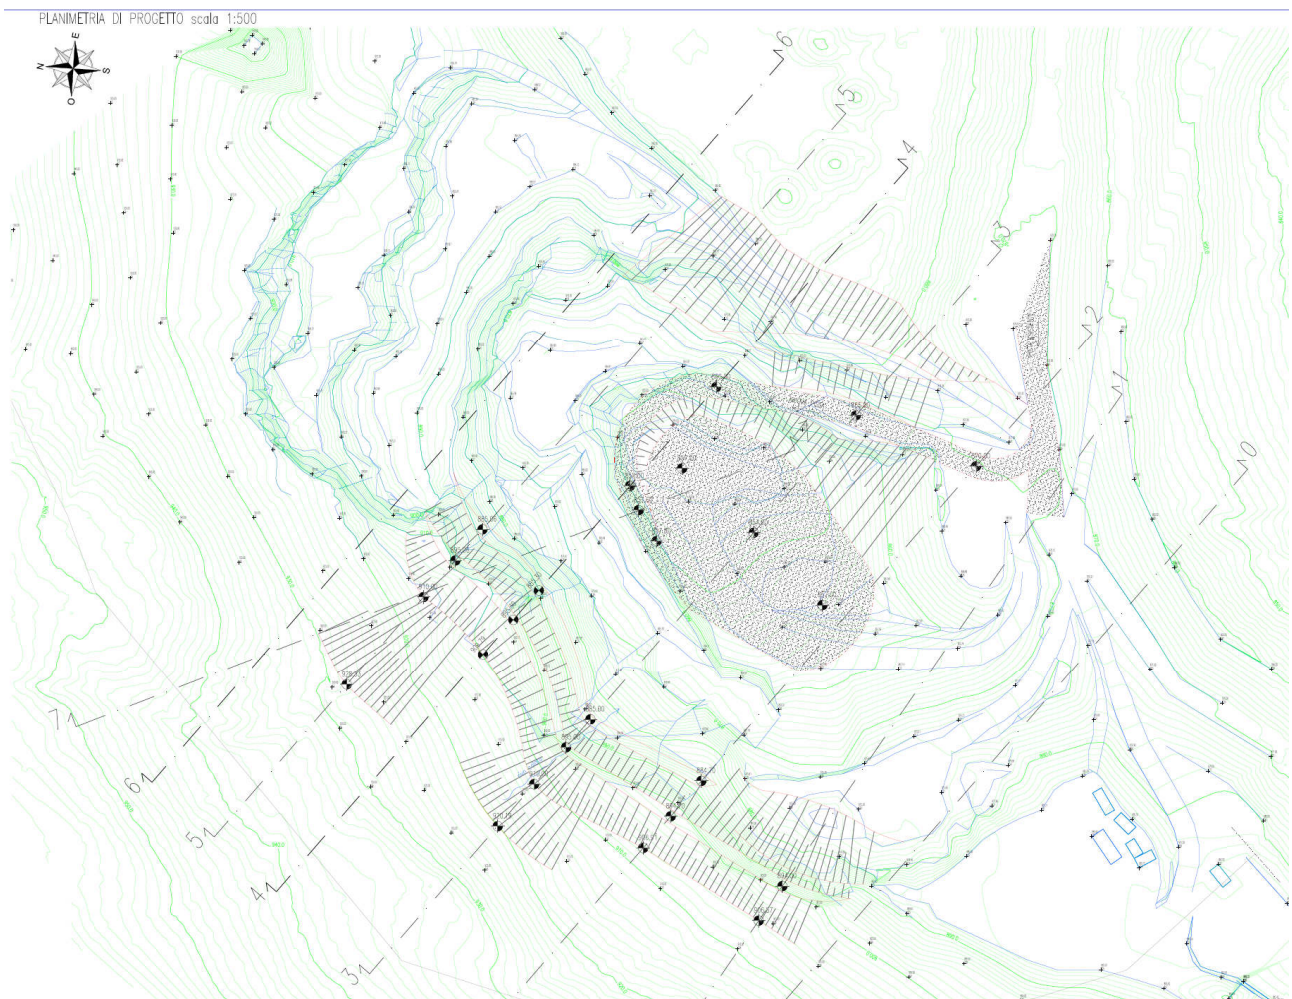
Estratto planimetria di progetto (scala a vista)
